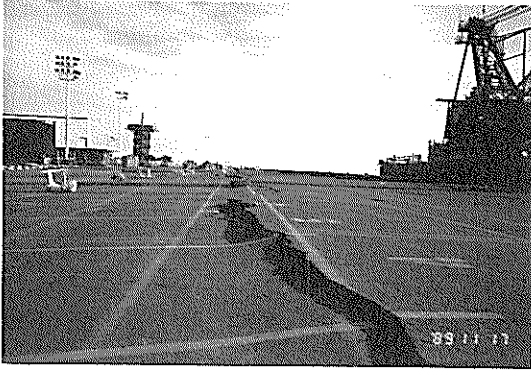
7th Street ターミナルの地盤沈下 (バース38)
